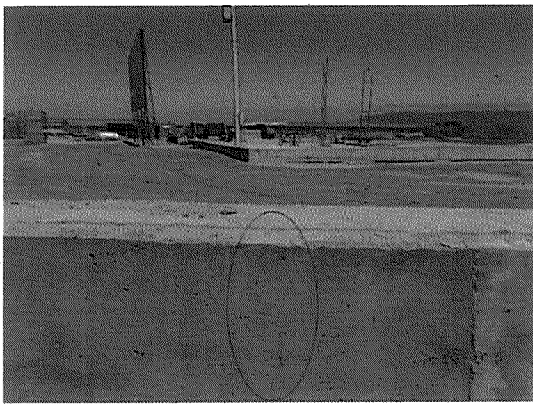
Muro de contención M1 agrietado.
